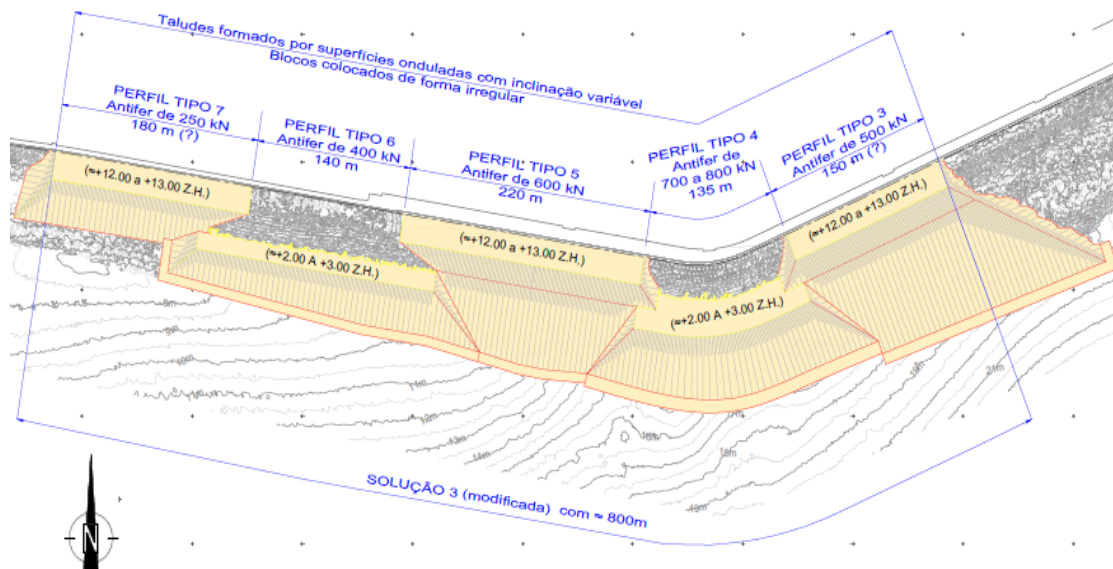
Planta das obras de reparação. Localização dos perfis-tipo do trecho a ensaiar.
